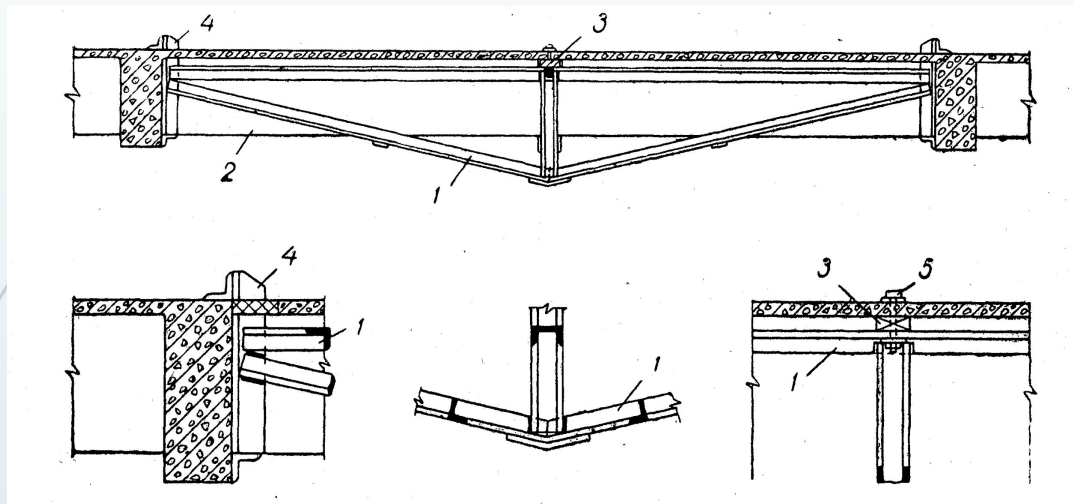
Усиление железобетонной балки упругой опорой, создаваемой
